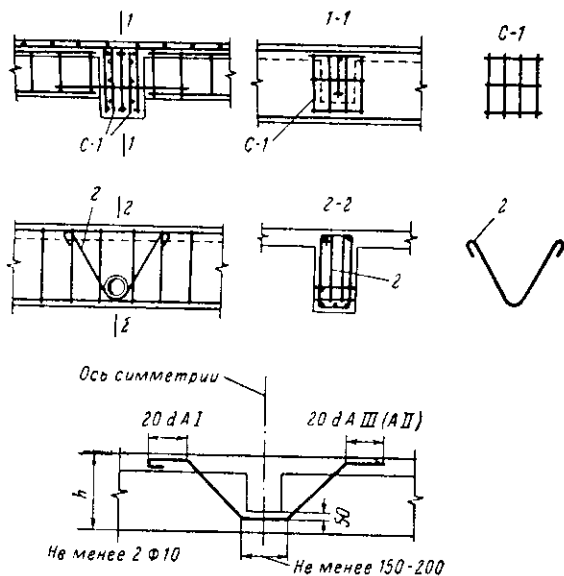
Дополнительное армирование балок в местах приложения сосредоточенных грузов
